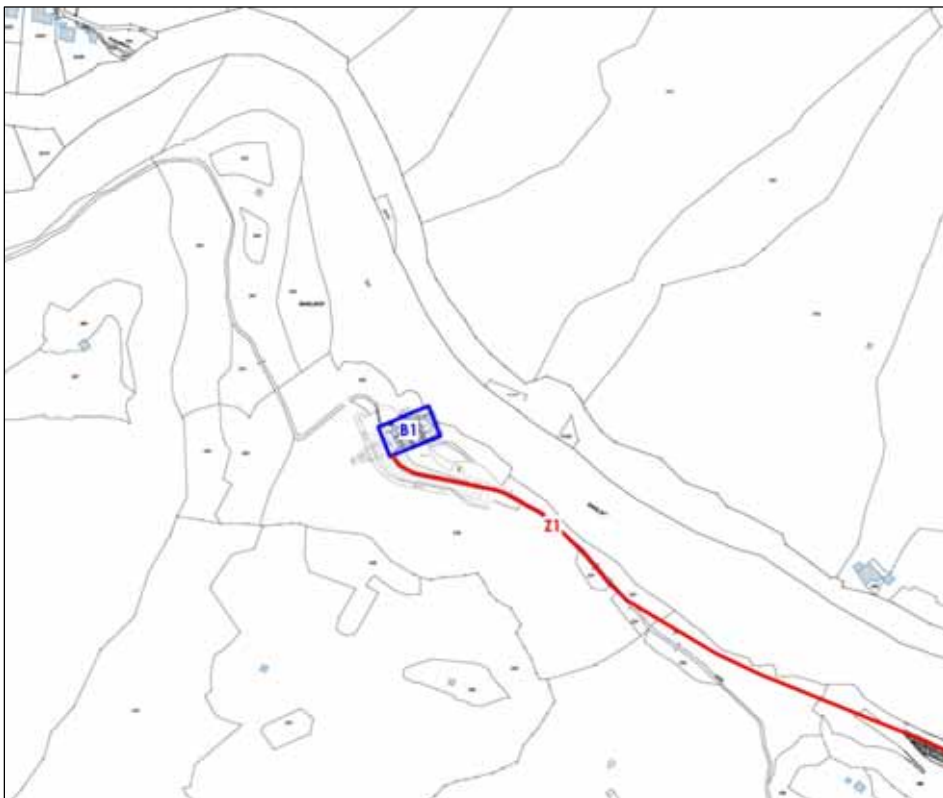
Lageplan mit Darstellung der Schallquellen für den Baustellenbetrieb V1
